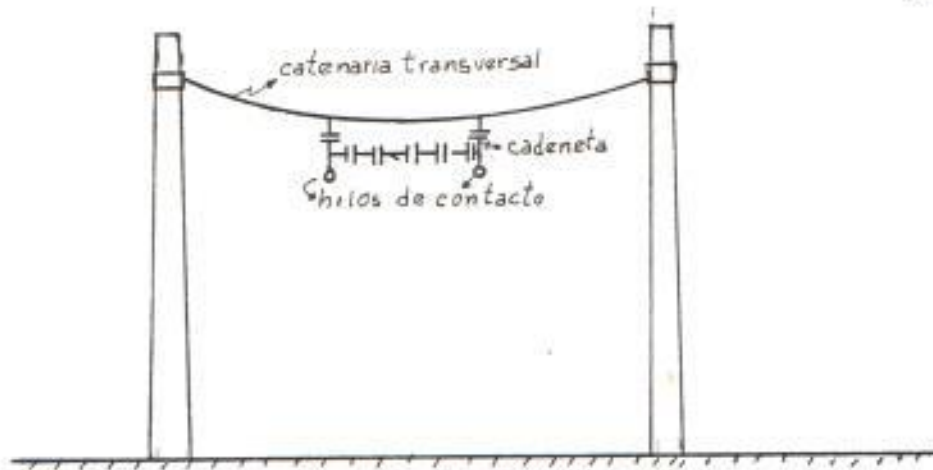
SOPORTE TIPO PORTICO
